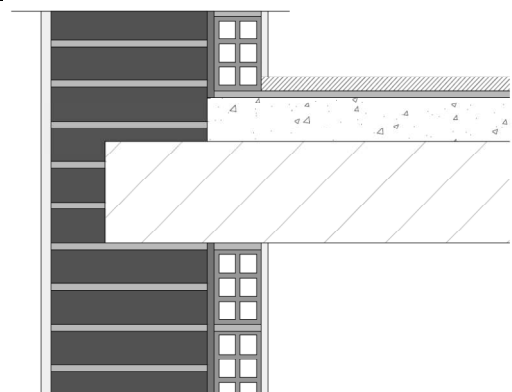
Fachada-Forjado (por vigüeta). Zona oeste. Estado original.
